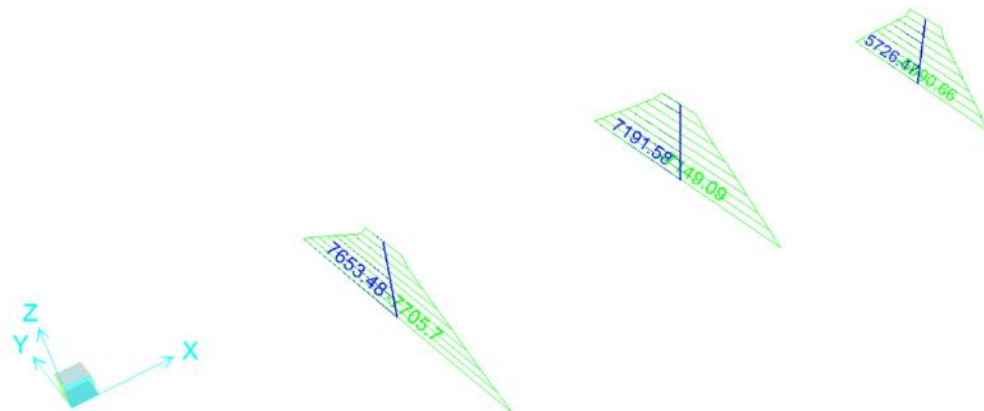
Diagrama momento transversal (KN.m) de las columnas puente Vía a Minca
